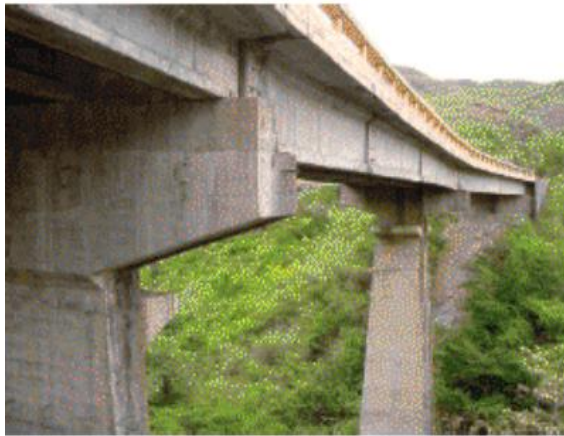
Superestructura de viga y losa en concreto preesforzado. Regional Nariño.
